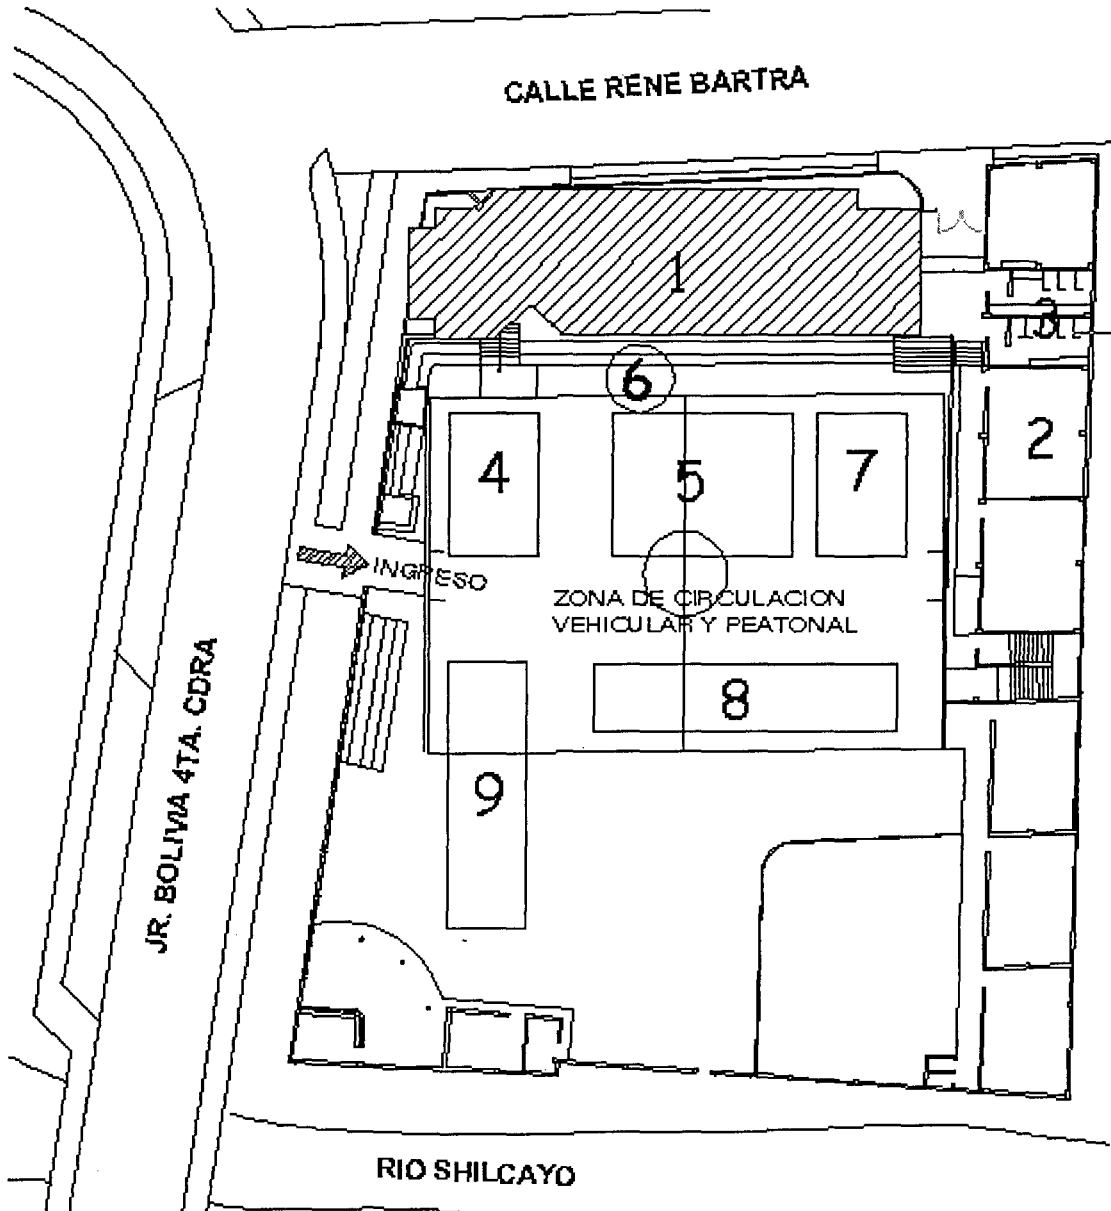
Distribución en planta de las áreas de trabajo (Layout plant)
